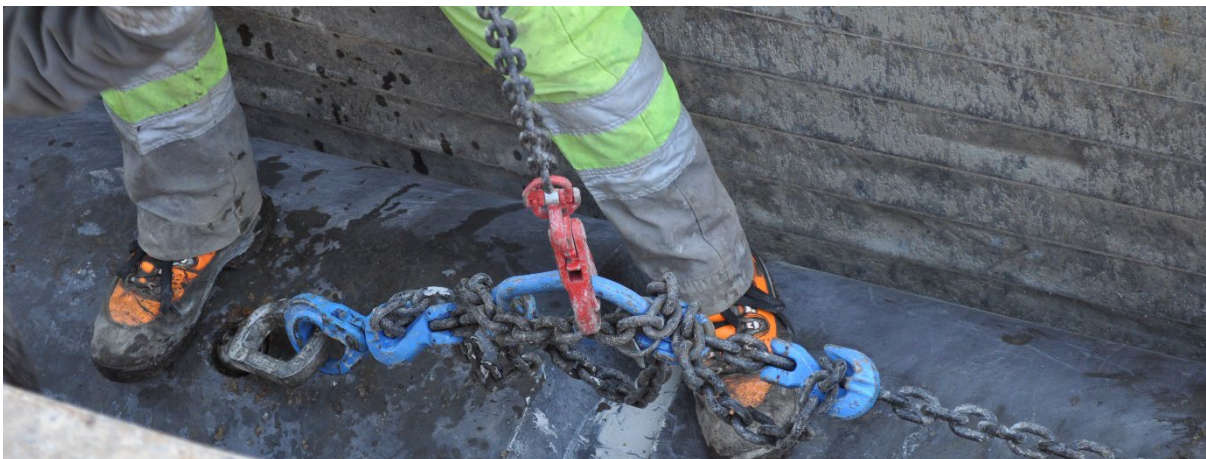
Bedingung ist ein fachgerechter Einbau der MAROWA® Hochleistungsbetonrohre
